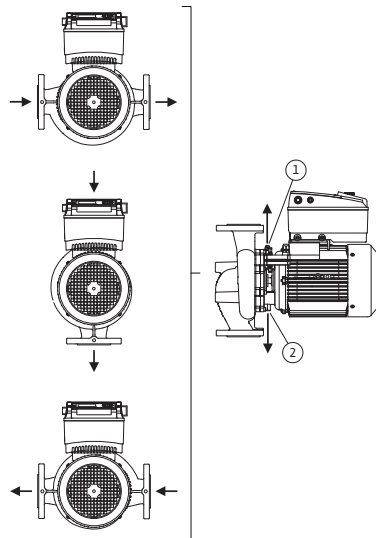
Tilladte installationspositioner med horisontal motoraksel
